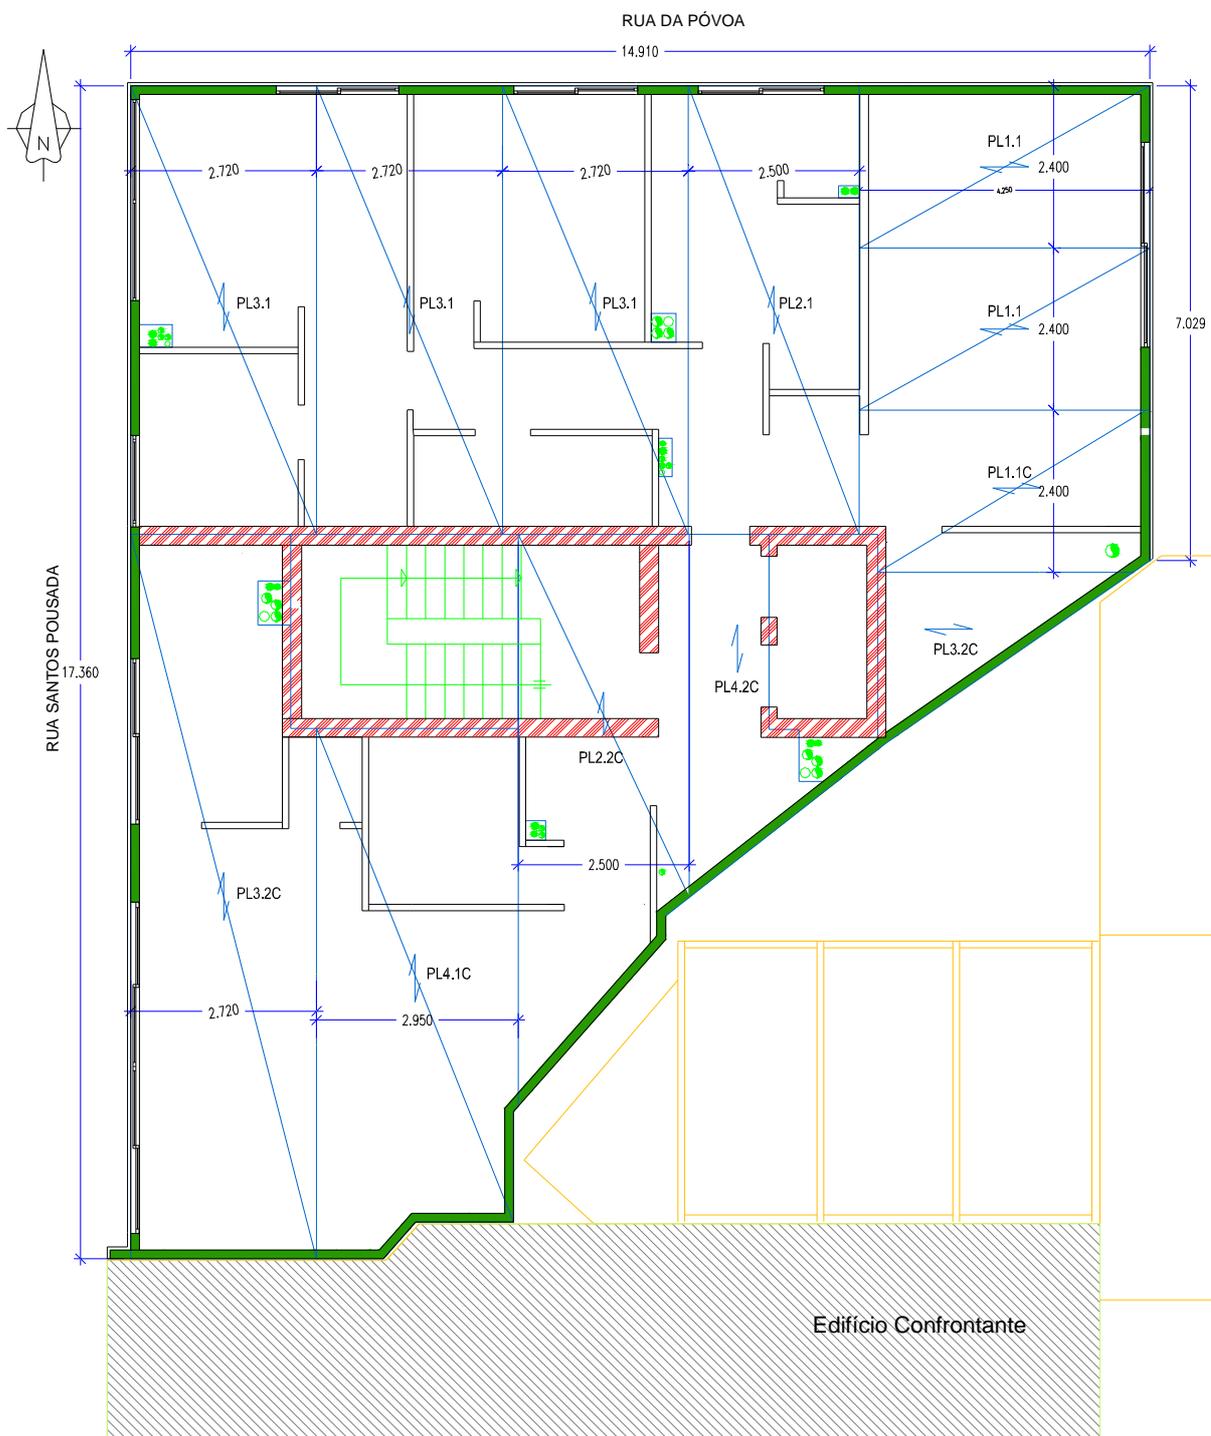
Planta de painéis de laje – piso-tipo
